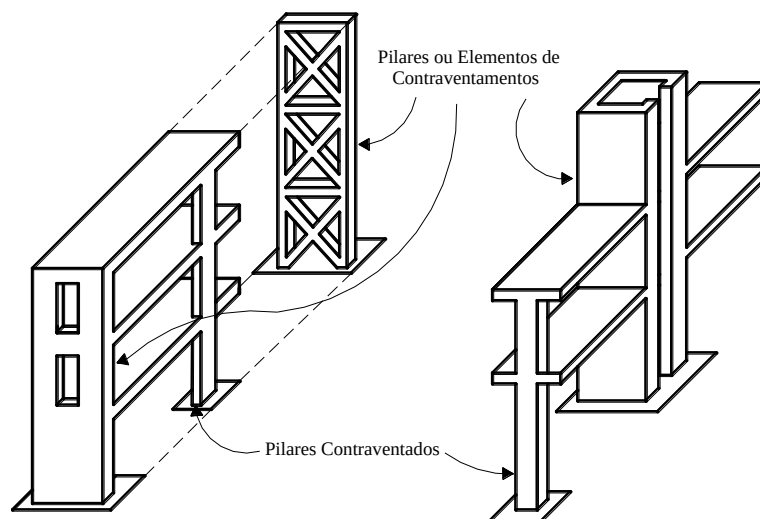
Pilares contraventados e elementos de contraventamento (FUSCO, 1981).
